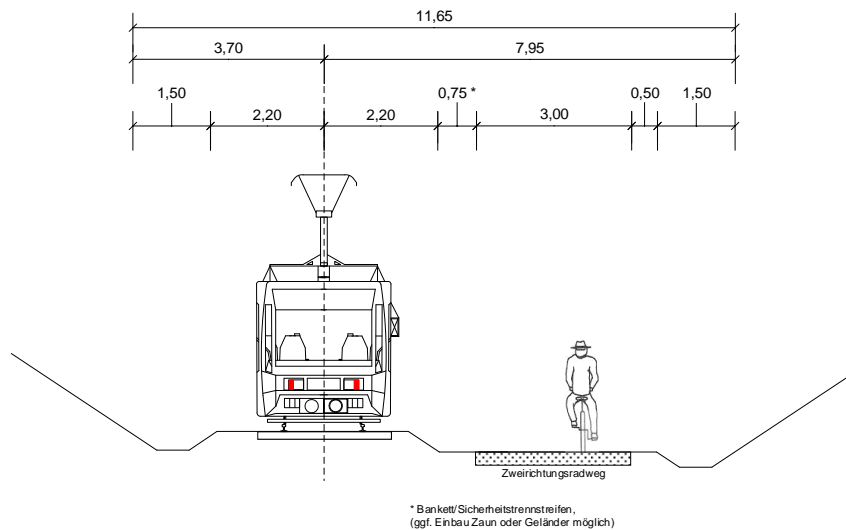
Querschnitt BOStrab Eingleisig mit parallelem Radweg im Einschnitt
